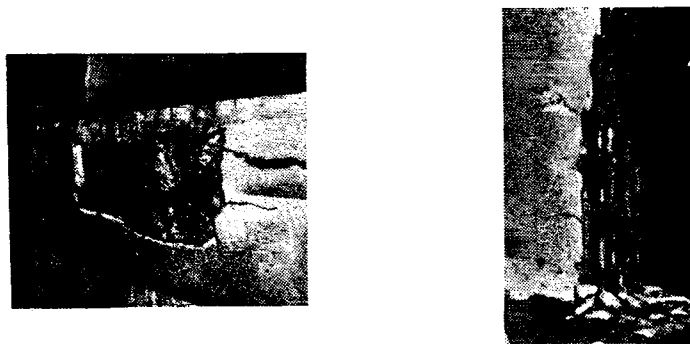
Разрушение защитного слоя с появлением трещин вдоль арматуры:
